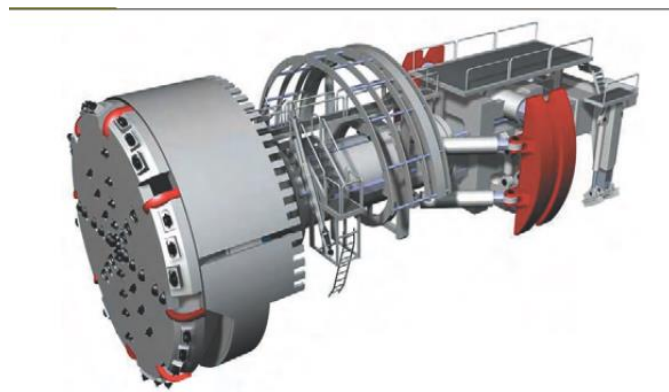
Tunnelier pour la construction du tunnel de base St. Gothard
